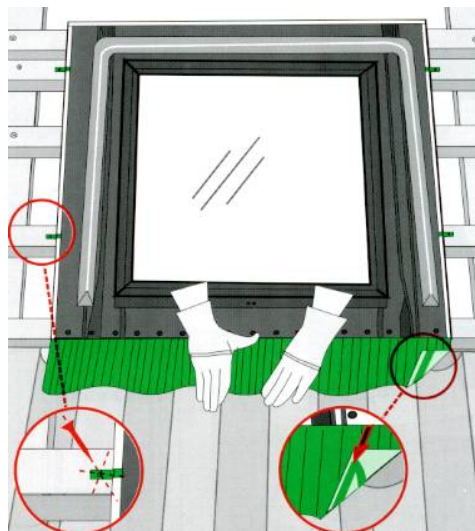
Montaż wyłazu dachowego [5, s. 137].
